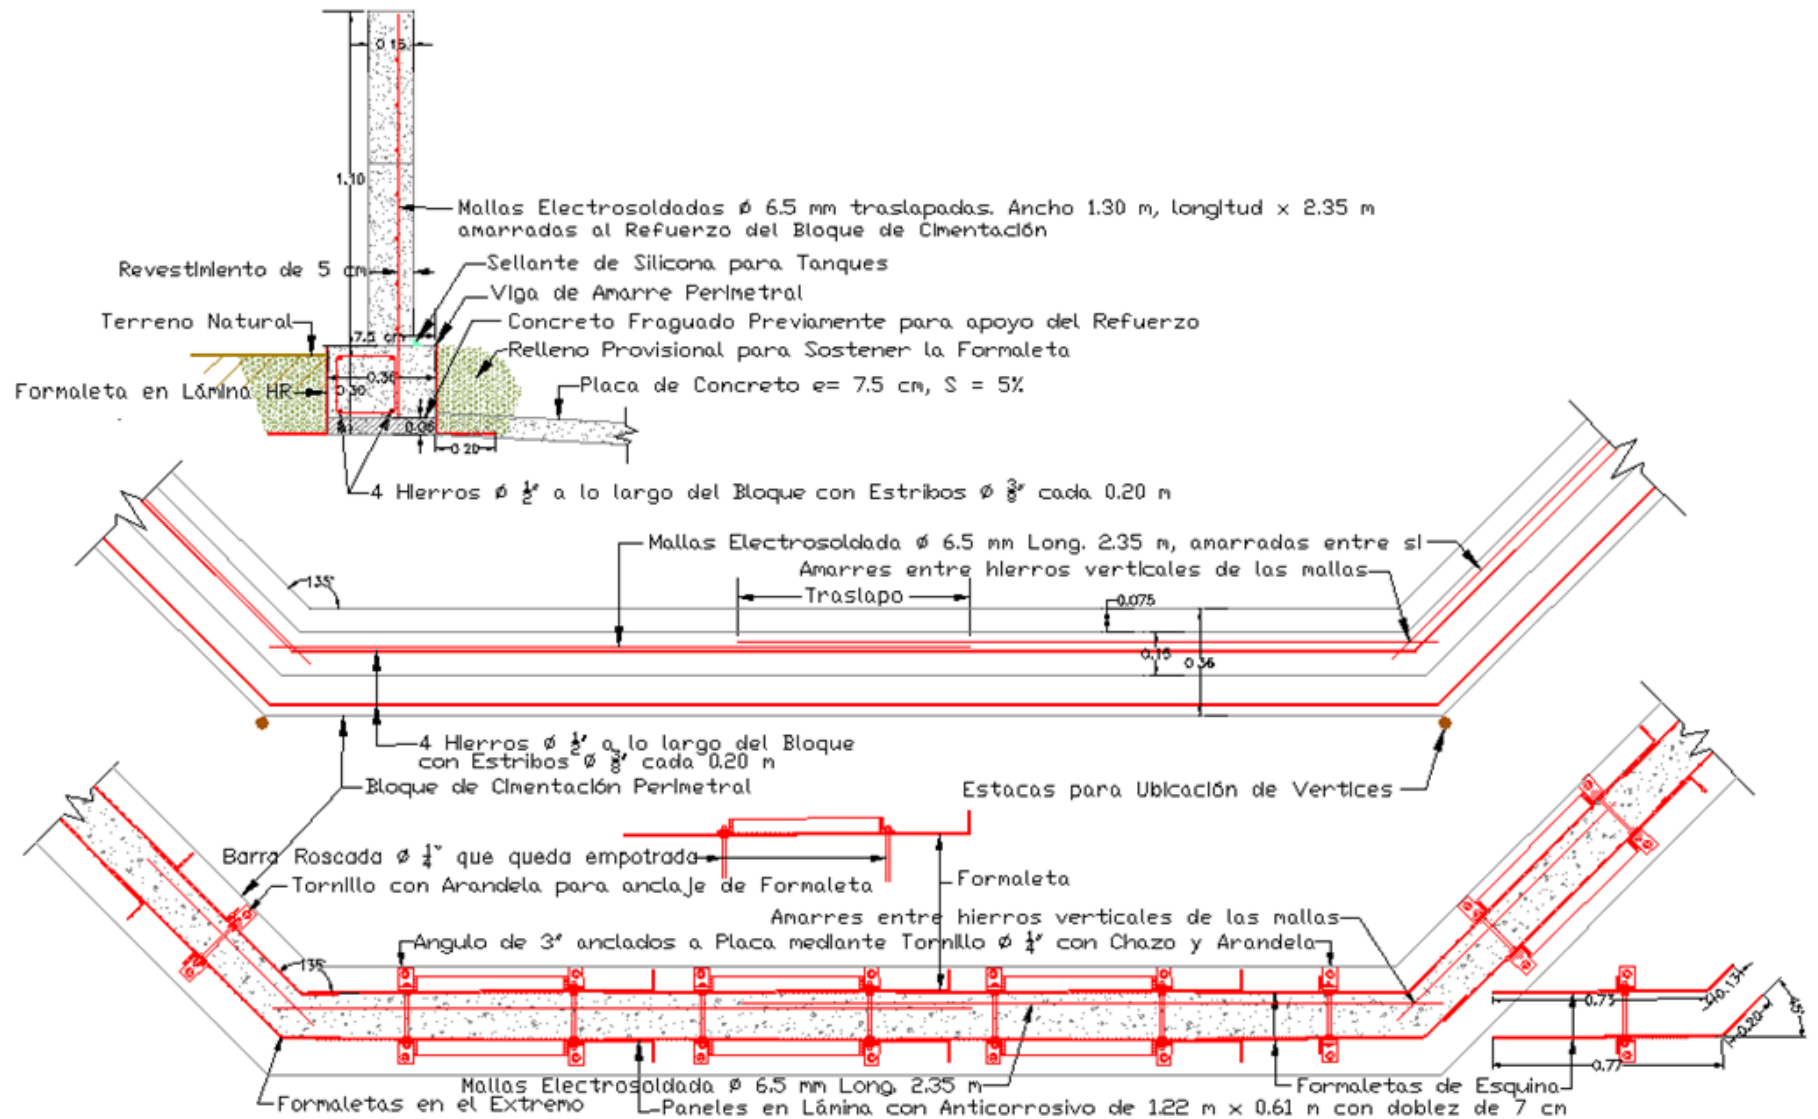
Construcción del Estanque en Concreto -Vista del Formateado y del Refuerzo en Acero
